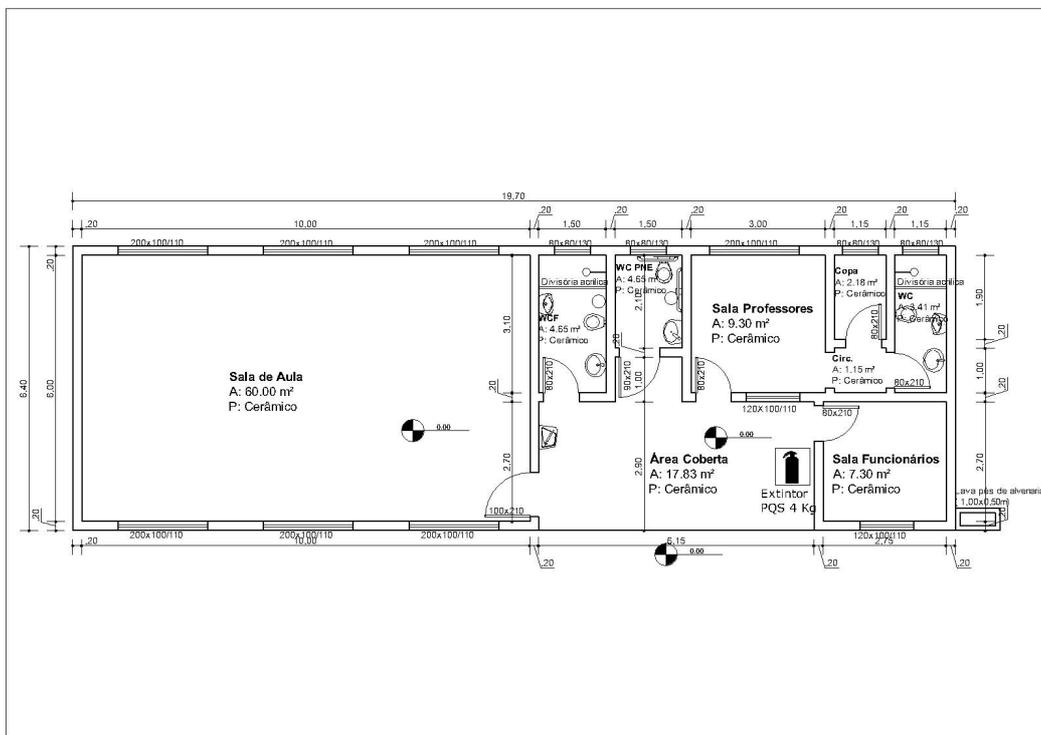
Planta baixa do prédio de sala de aula e sala de professores.
